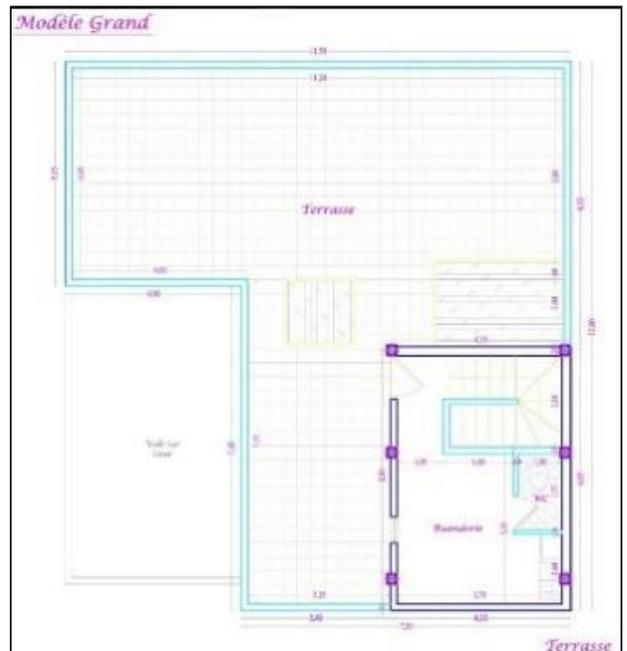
plan de Terrasse du type grand. Source : fondation amidoul
